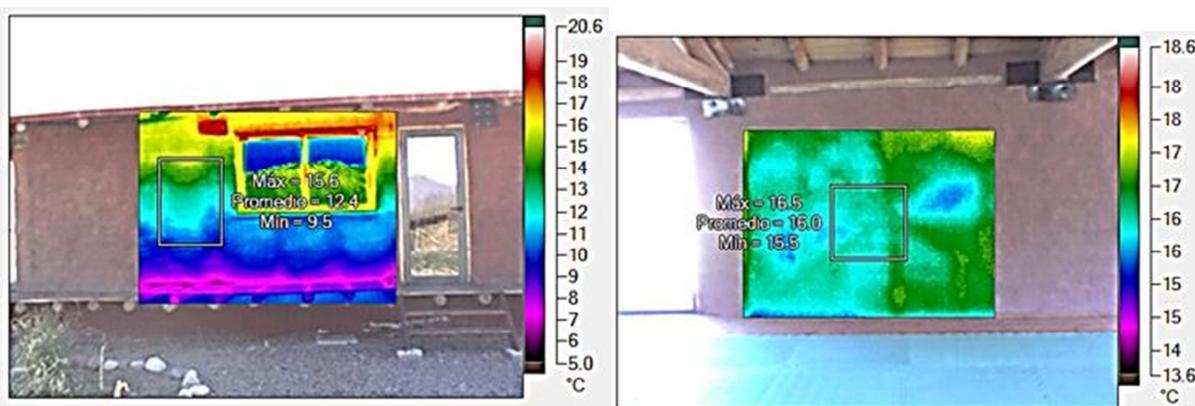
Izq.: Cara exterior del muro Sur. Der.: Cara interior del muro Oeste.
